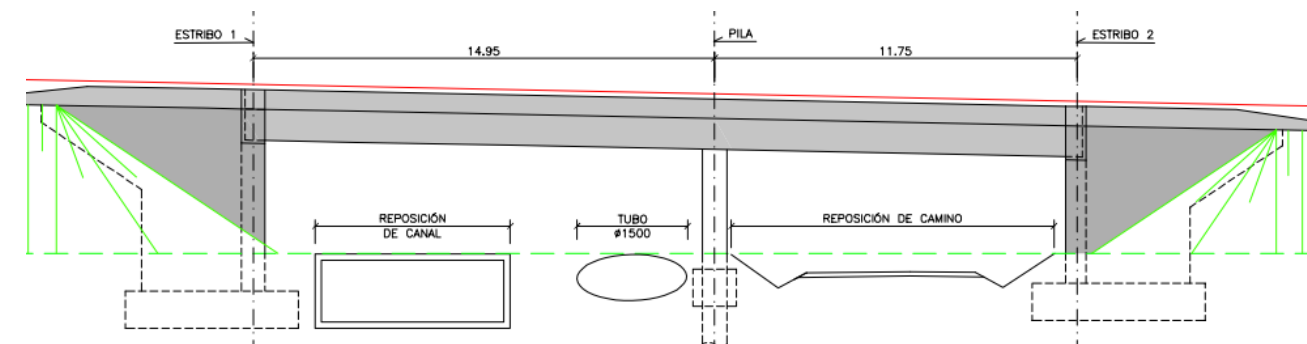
ALZADO PI TERCER CANAL DE RIEGO DE LEVANTE Y CAMINO P.K. 3+600
